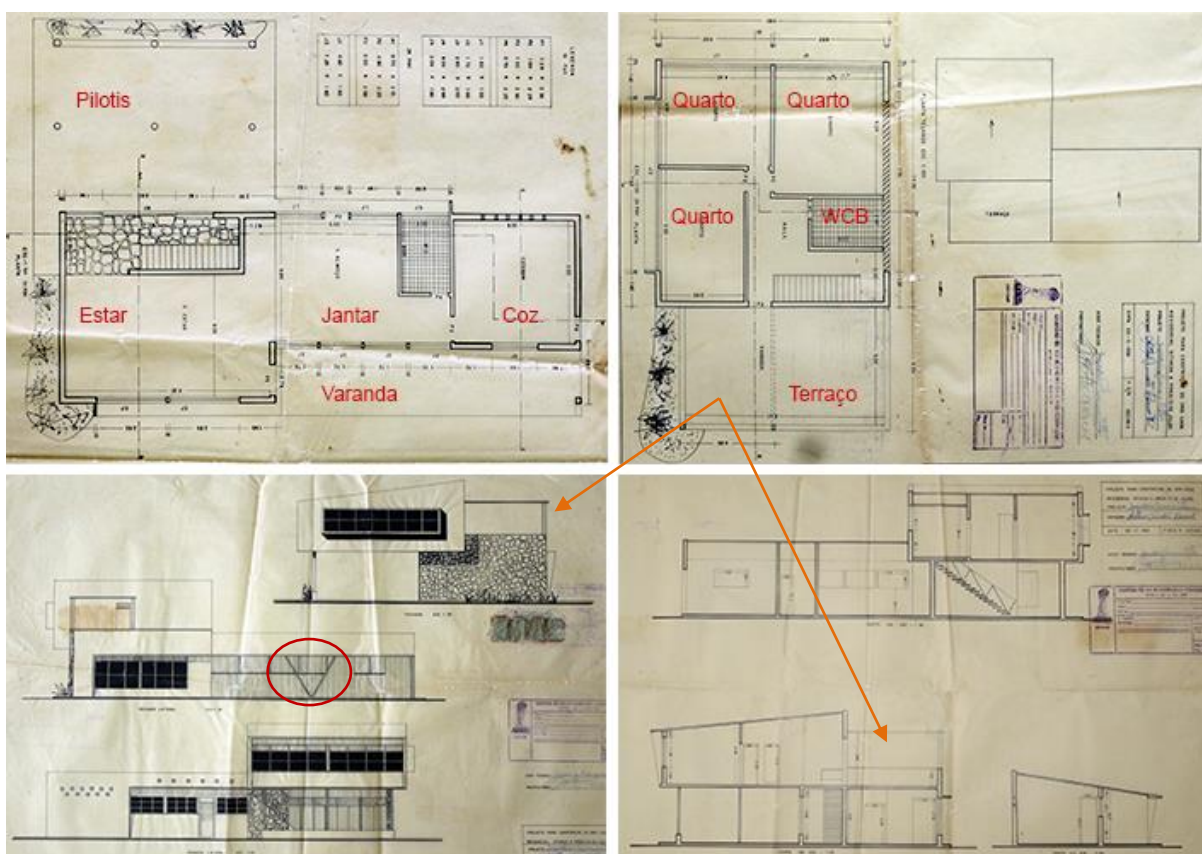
Pranchas do projeto da Res. Oneildo Tavares (1956). Planta pavimento térreo (superior esquerdo), Planta do 1º pavimento (superior direito), Fachadas (inferior esquerdo) e Cortes (inferior direito). Destaque circular para o pilar em “V” na varanda lateral da casa e em setas para área do terraço, posteriormente fechada para abrigar mais dois quartos. Fonte: Arquivo Público da Cidade de Aracaju, editado pelos autores.
